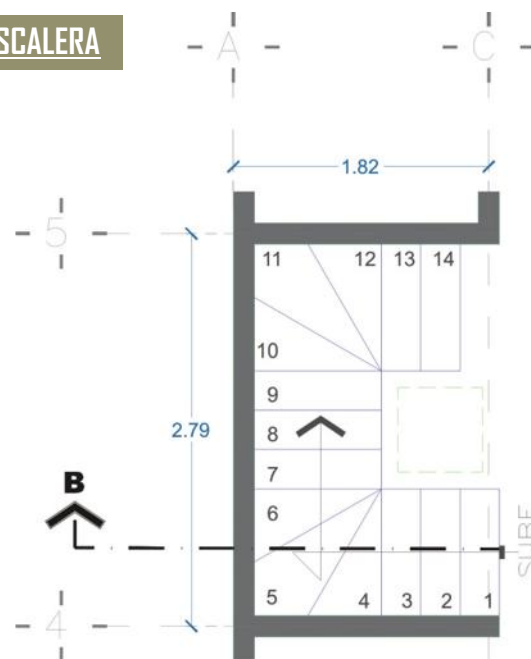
PLANTA DE ESCALERA (SAUCE).
